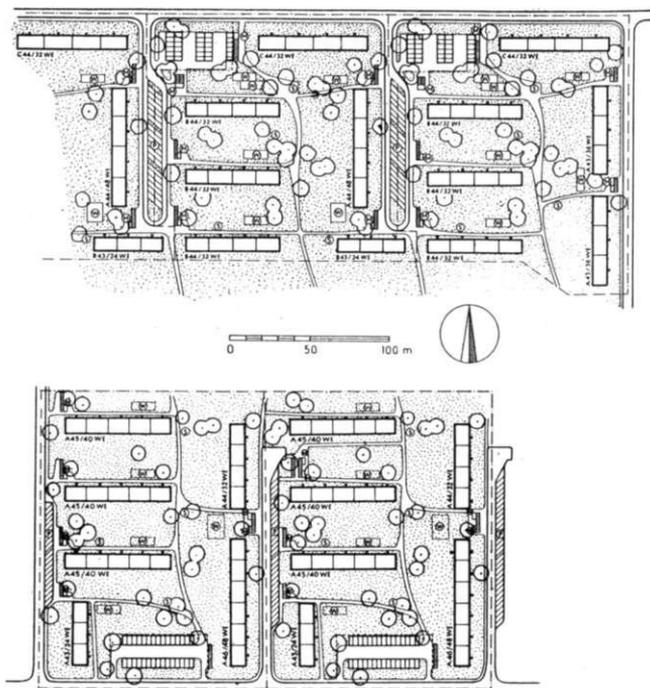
Präzisiertes Bebauungsplan für den zentralen Bezirk, 1960
